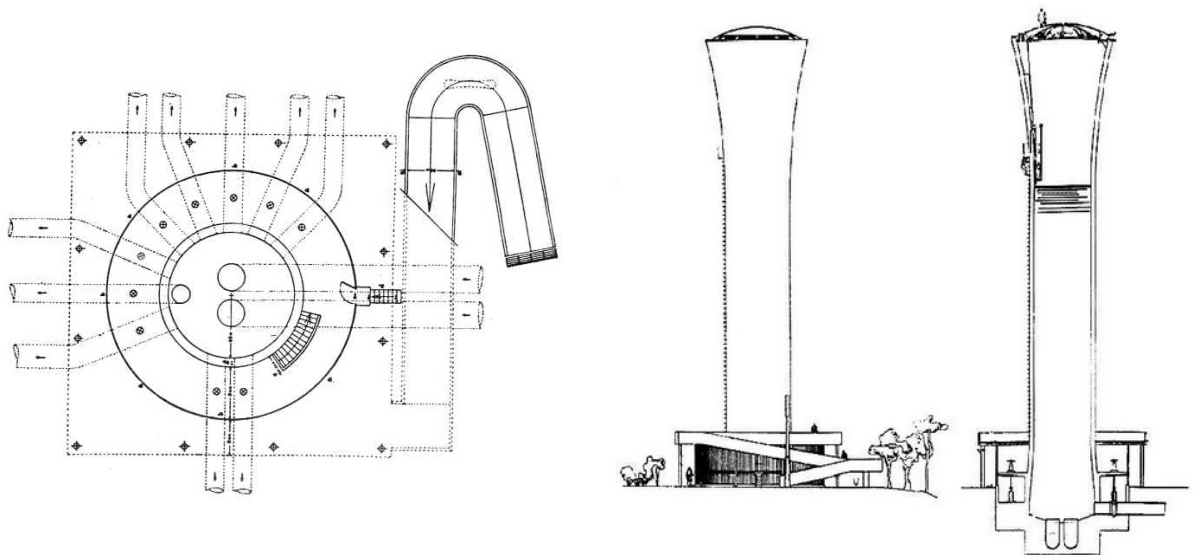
Torre D'Água Ribeirão das Lages. Planta-baixa, elevação e corte. Fonte: PAPADAKI, 1950.
